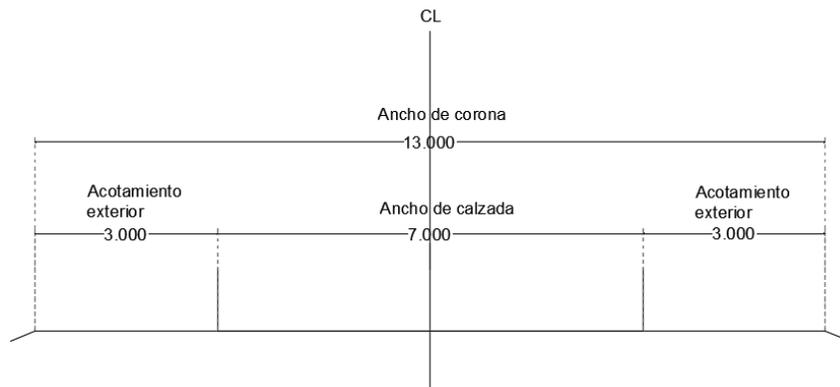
Sección transversal tipo de las carreteras tipo ET2 en México.
